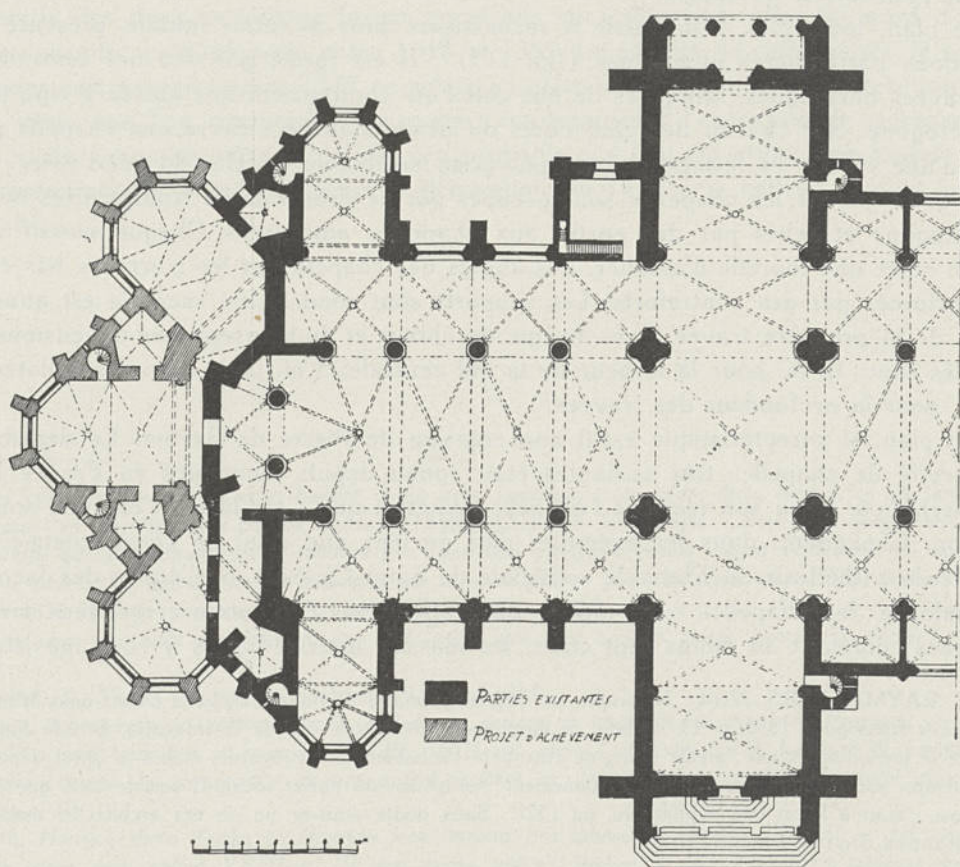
Diest, Collégiale Saint-Sulpice, plan terrier
